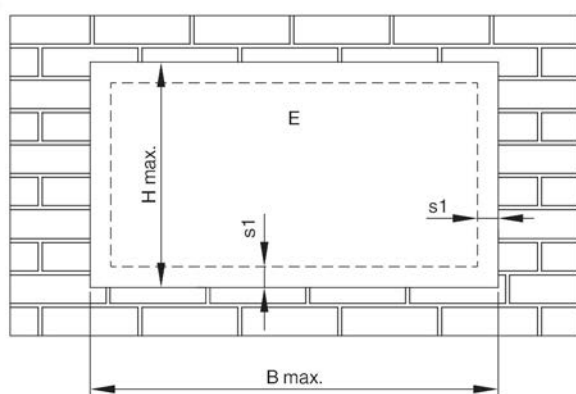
Огнестойкая плита – установка в сплошной стене, легкой перегородке или в стене с деревянным каркасом
